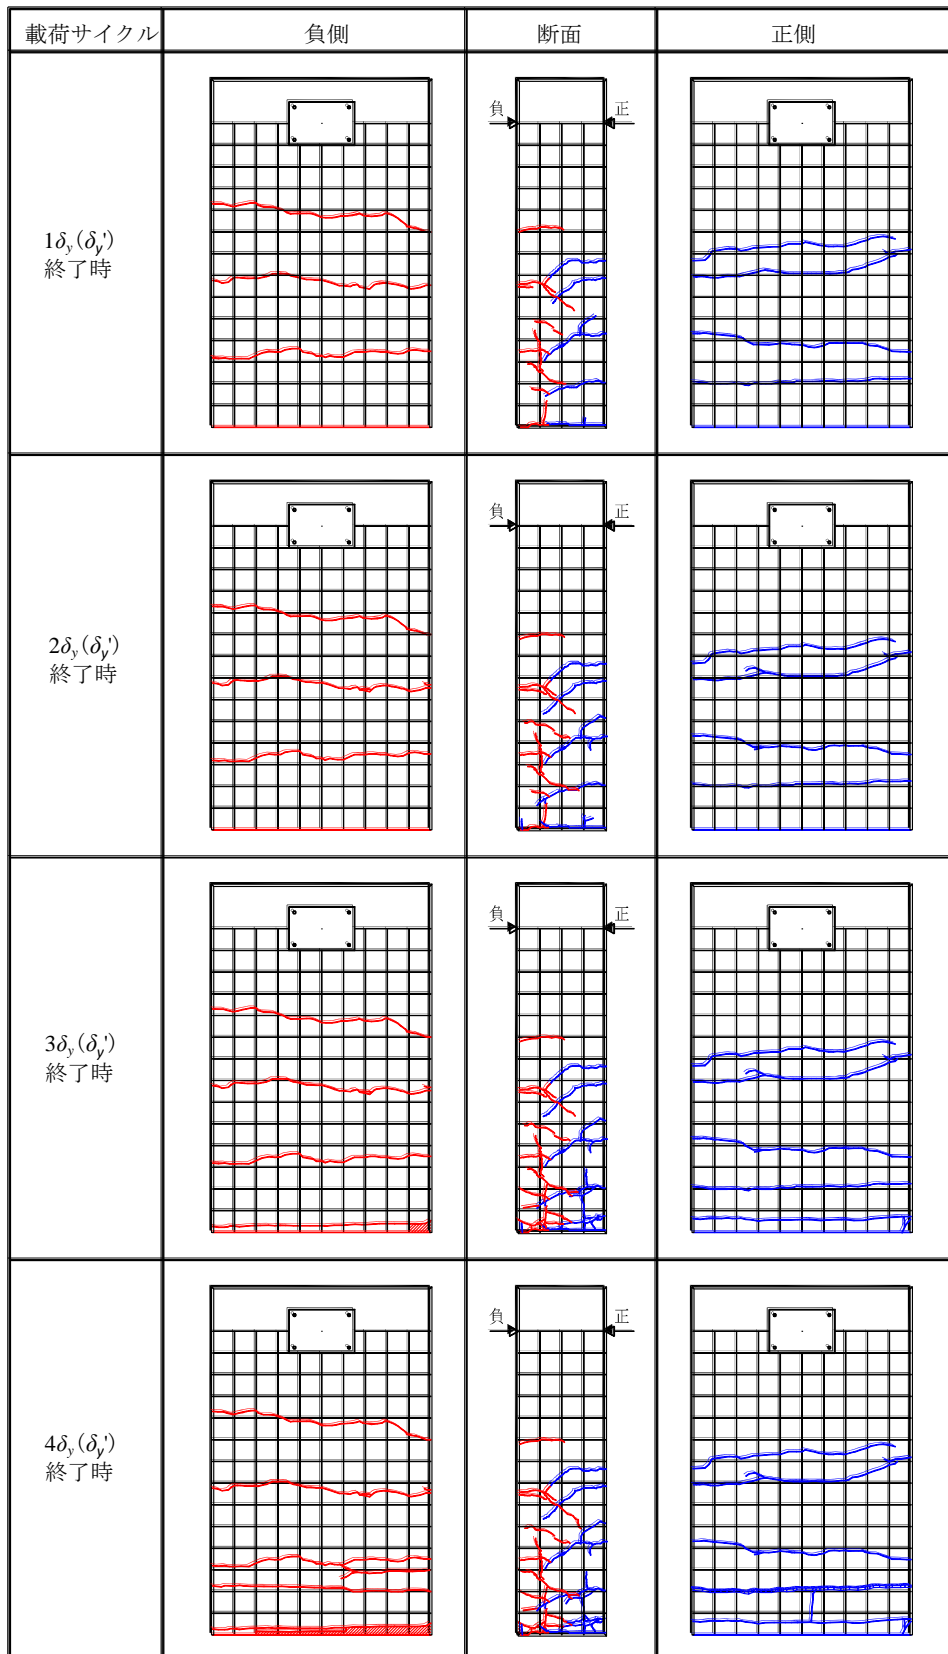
ND25A 試験体ひび割れ図 ($1\delta_y \sim 4\delta_y$)
